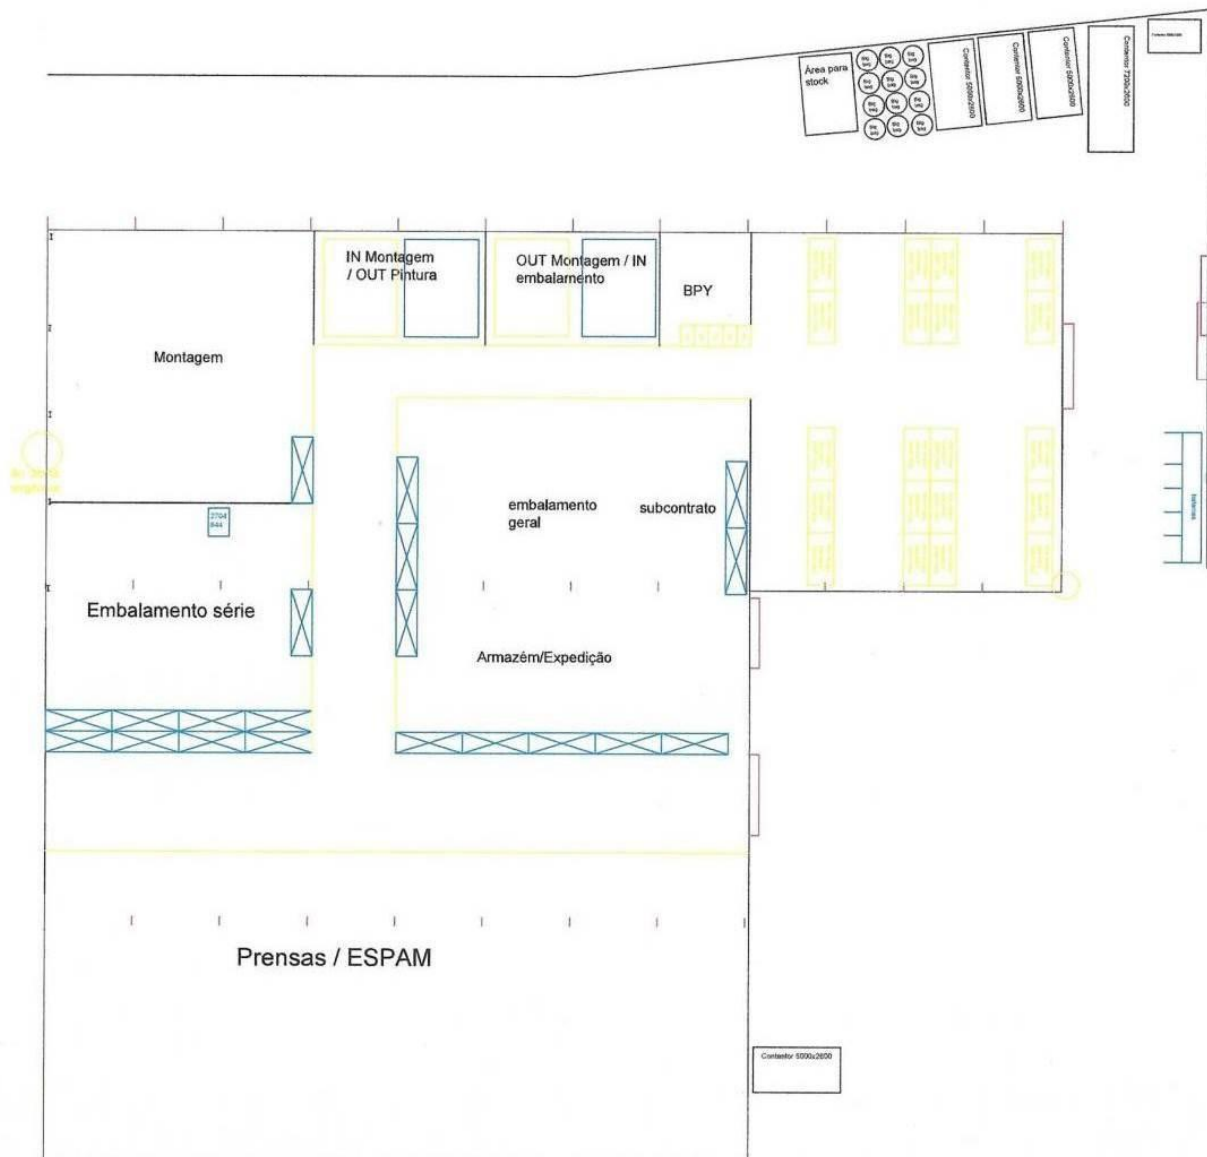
Planta do Pavilhão 2 do Chão de Fábrica
